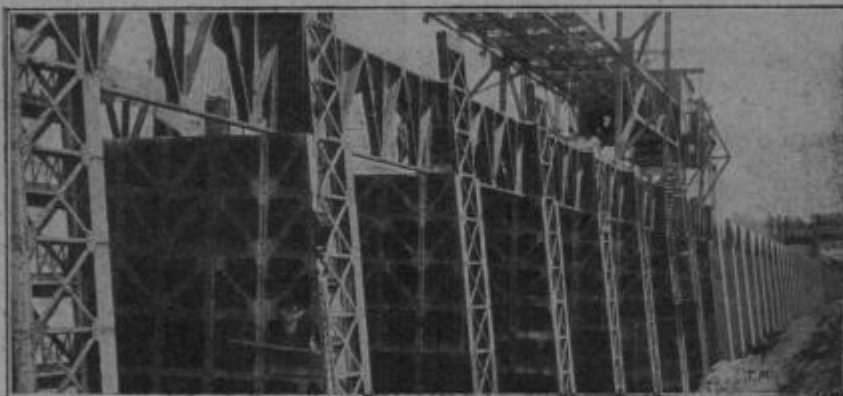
Usine de Keokuk. — Vue des moules d'acier mis en place pour la construction du barrage.
